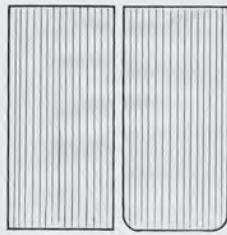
Gradschnitt, auch Flachschnitt, Schindel- oder Rechteckschnitt, englischer Schnitt, mit geraden oder abgerundeten Ecken – die älteste Form
